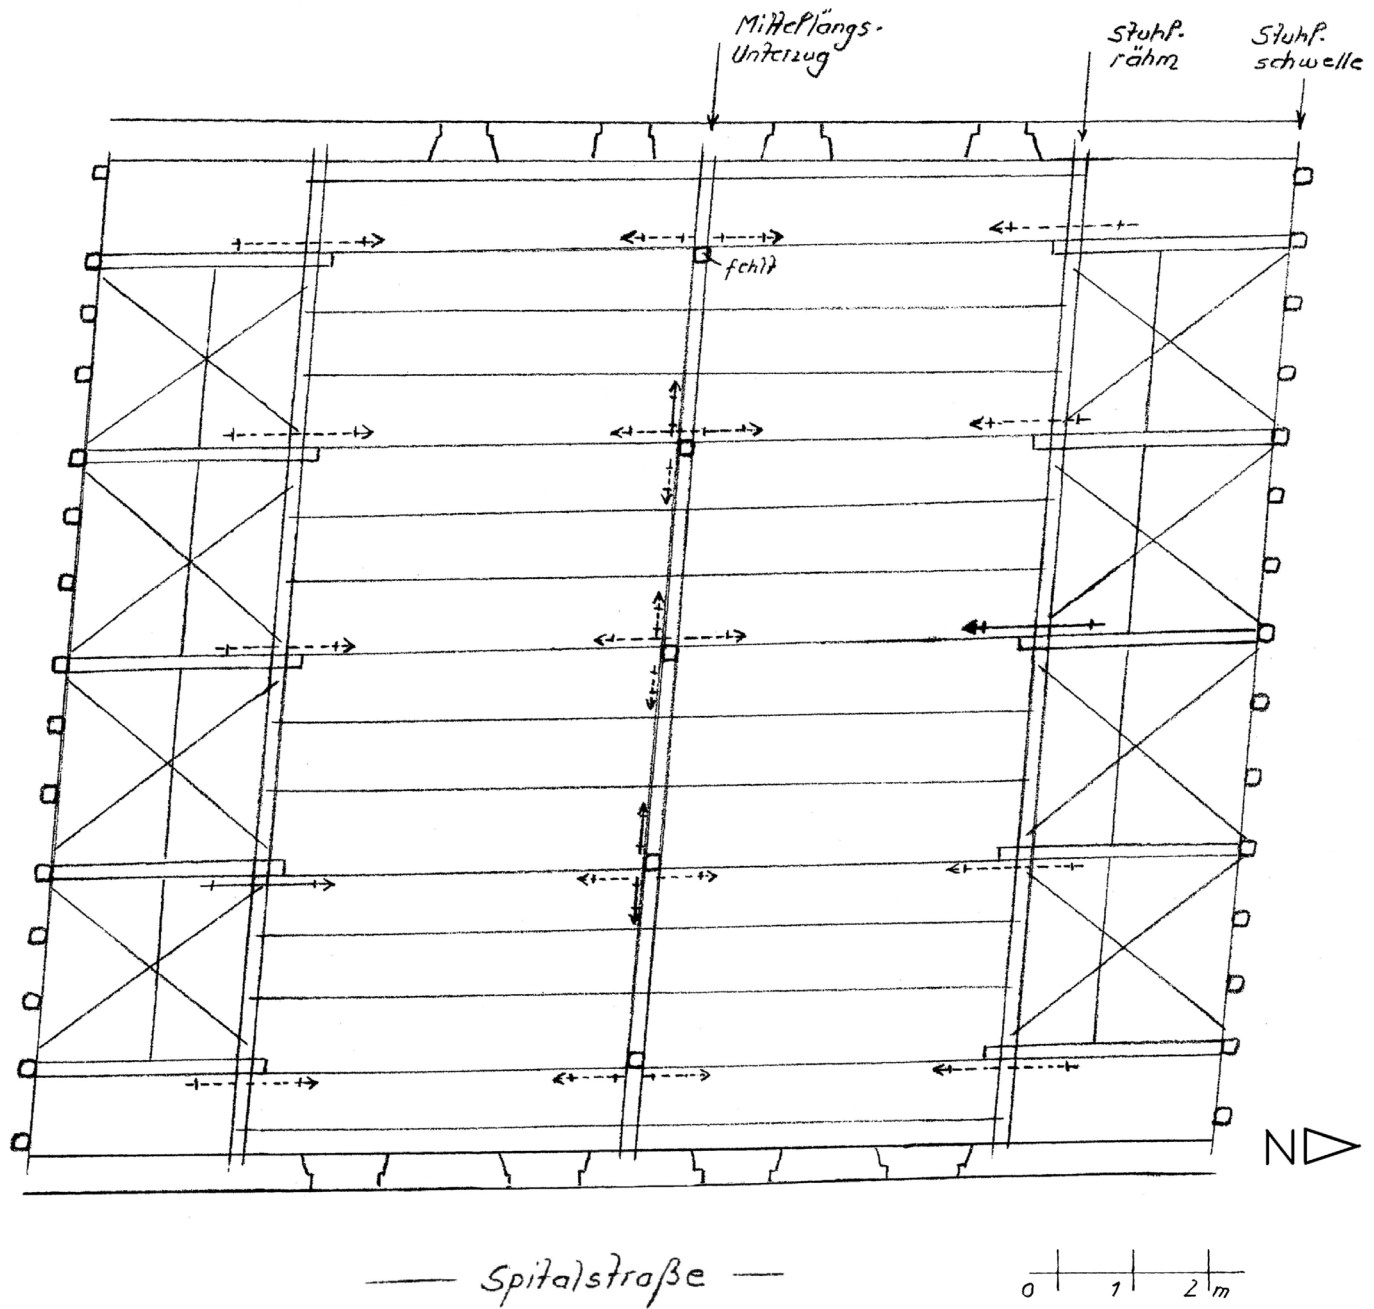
Spitalstraße 33, Grundriss 1. Dachgeschoss, 1580 (d).
